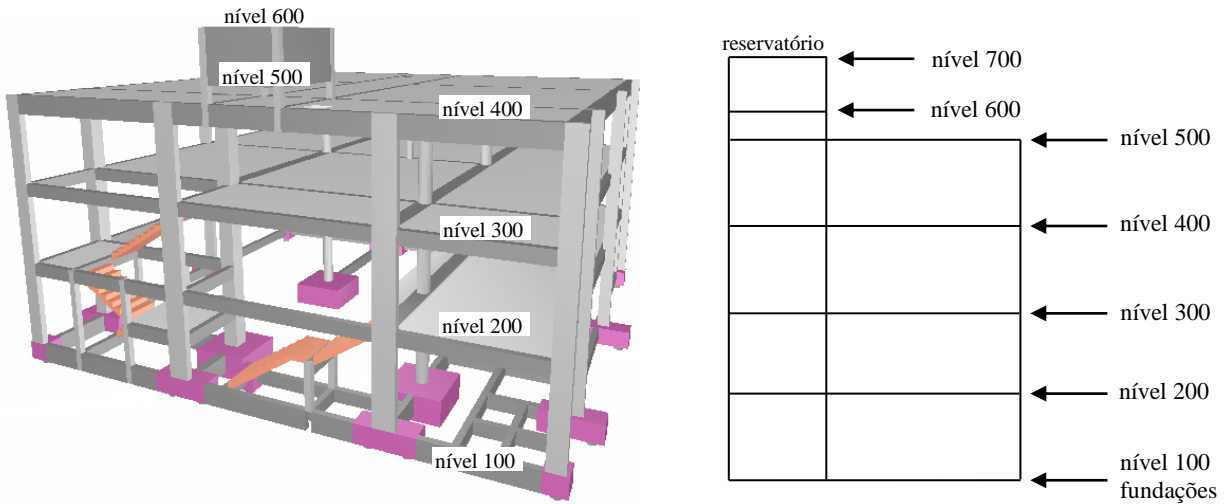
Numeração de vigas em função dos níveis dos pavimentos.
